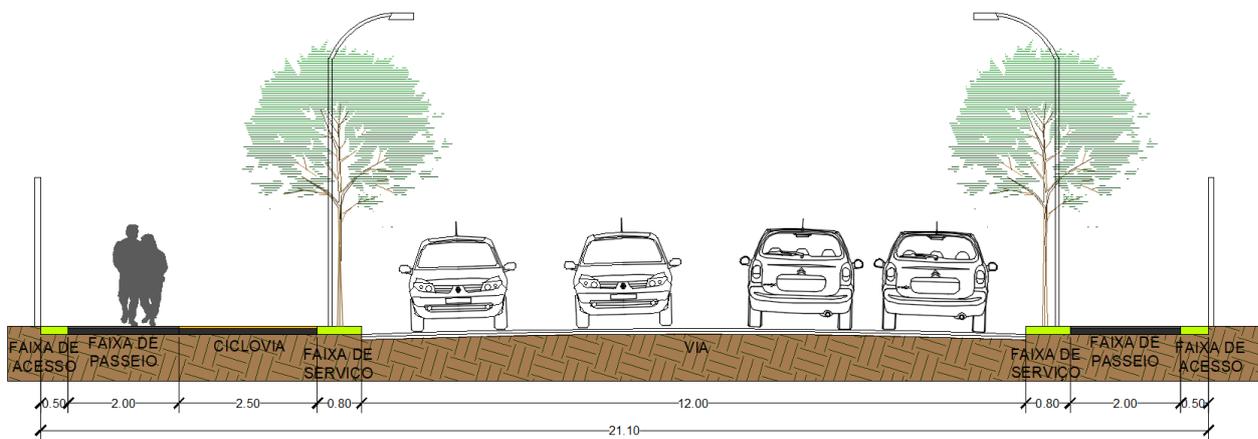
Perfil da Via de Circulação – Perfil 1 (Fonte: Própria)
